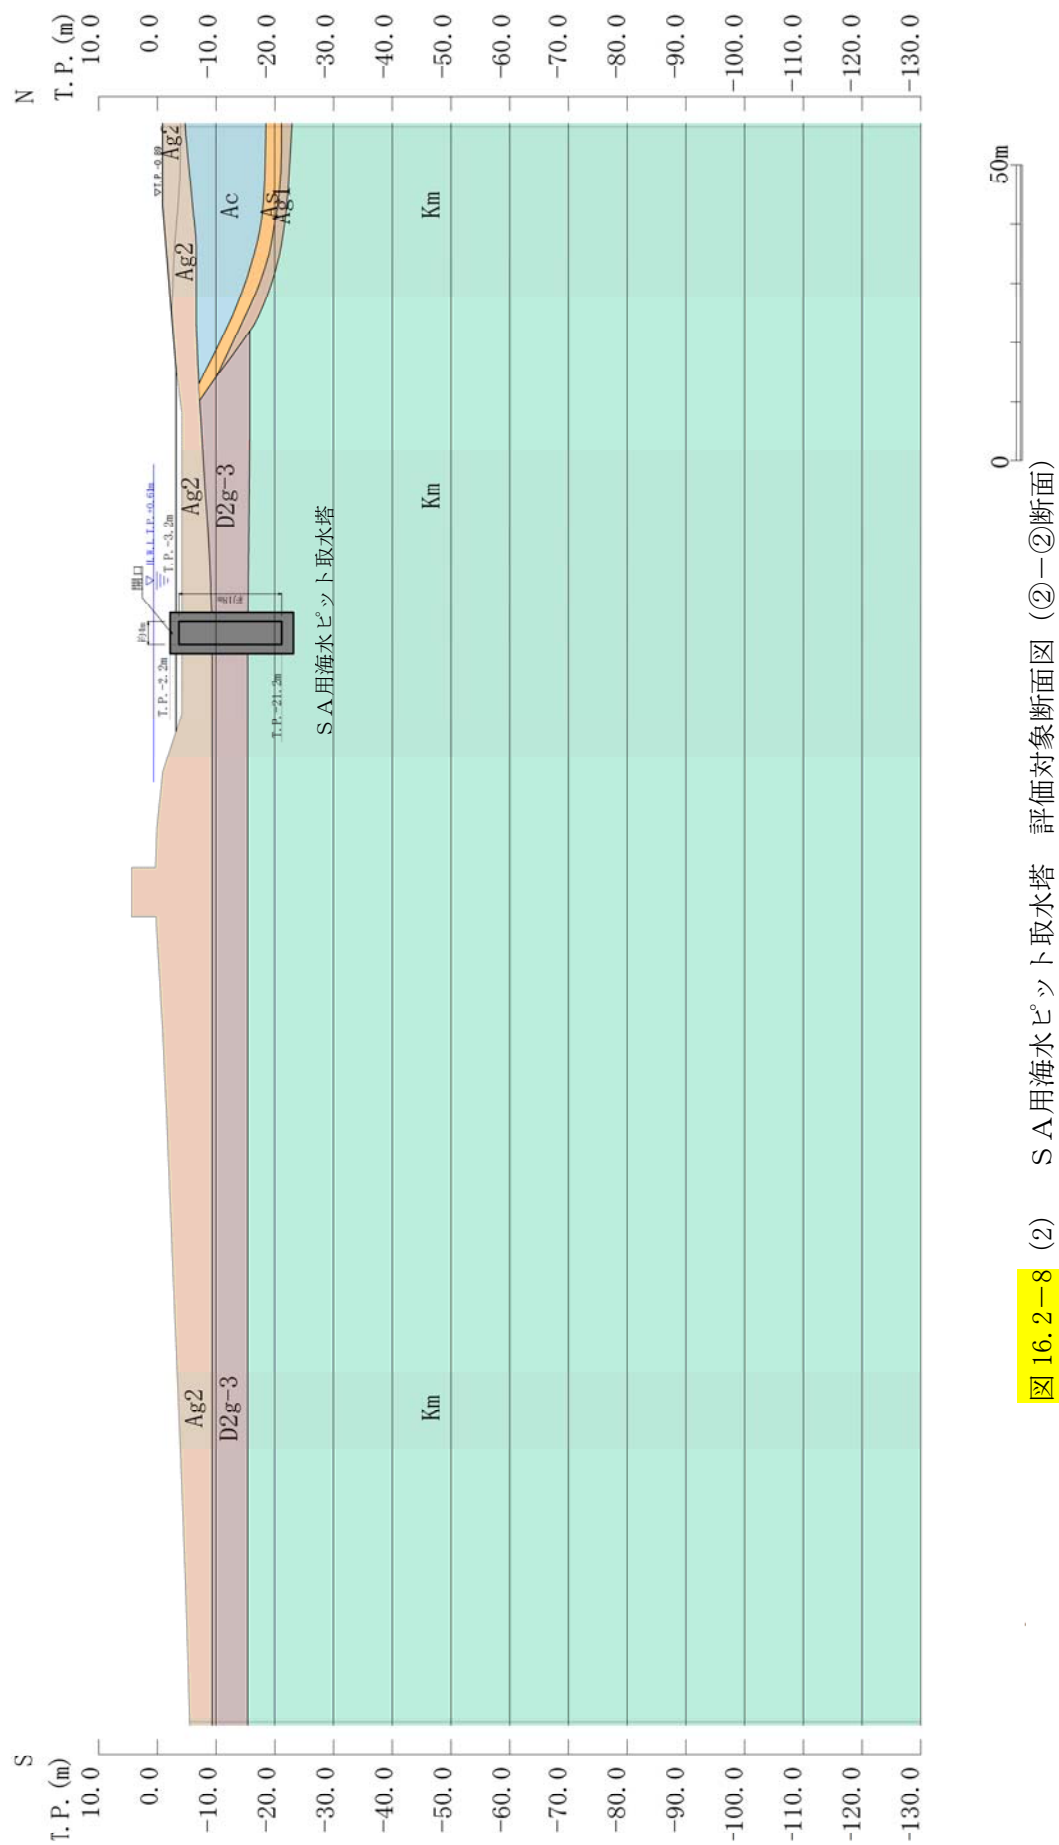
(2) SA用海水ピット取水塔 評価対象断面図 (②-②断面)
